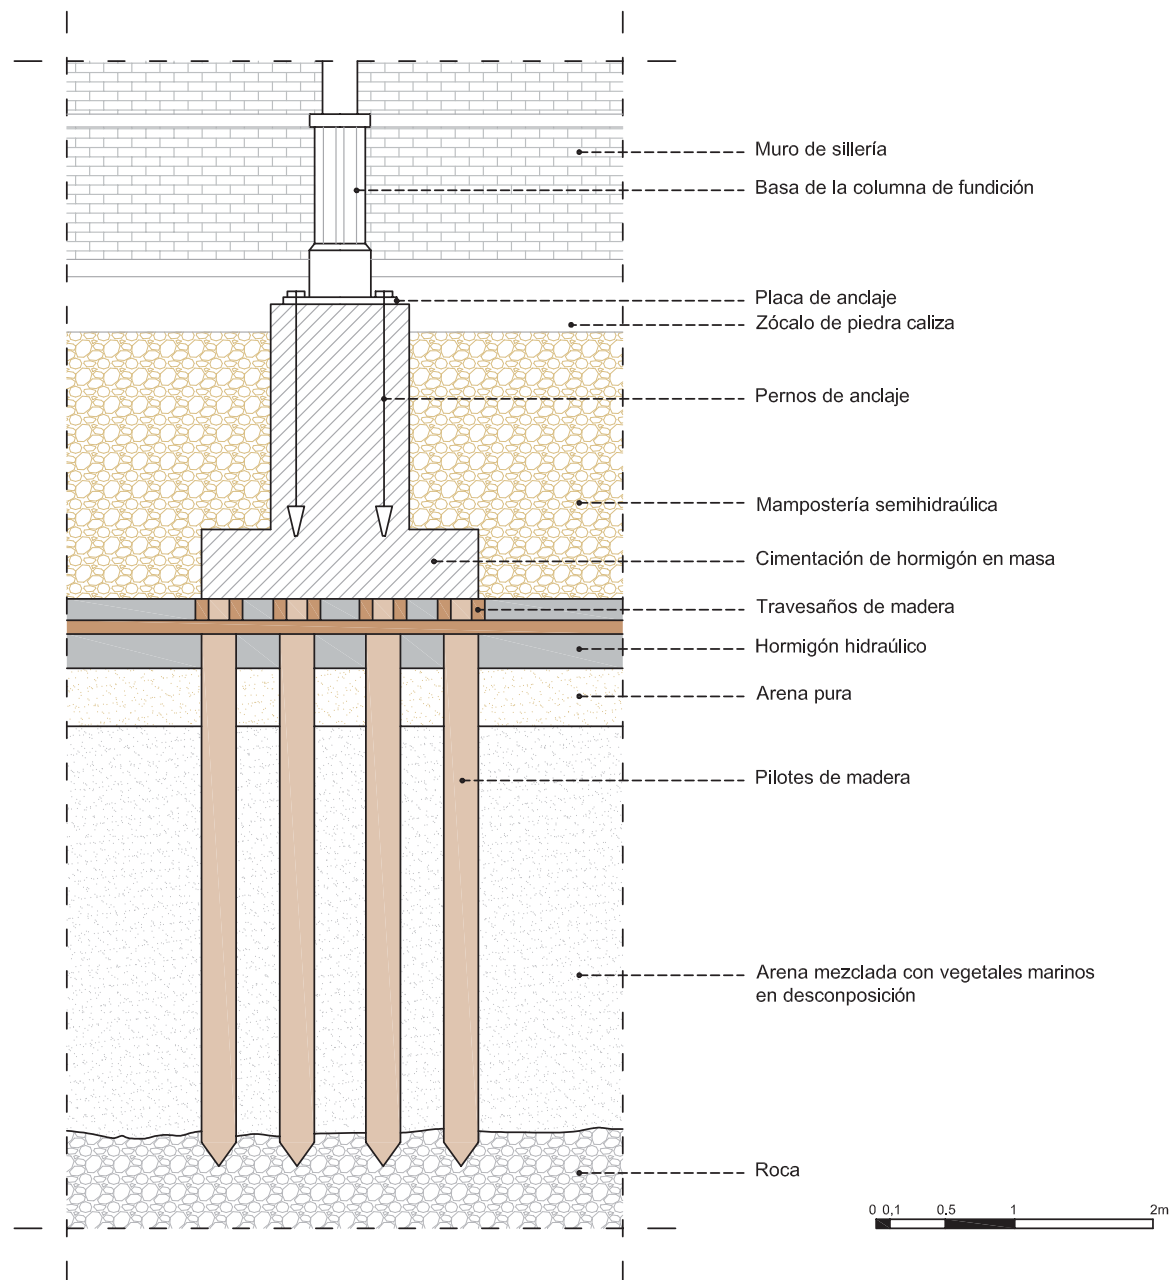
Detalle constructivo encuentro columna de fundición-cimentación
